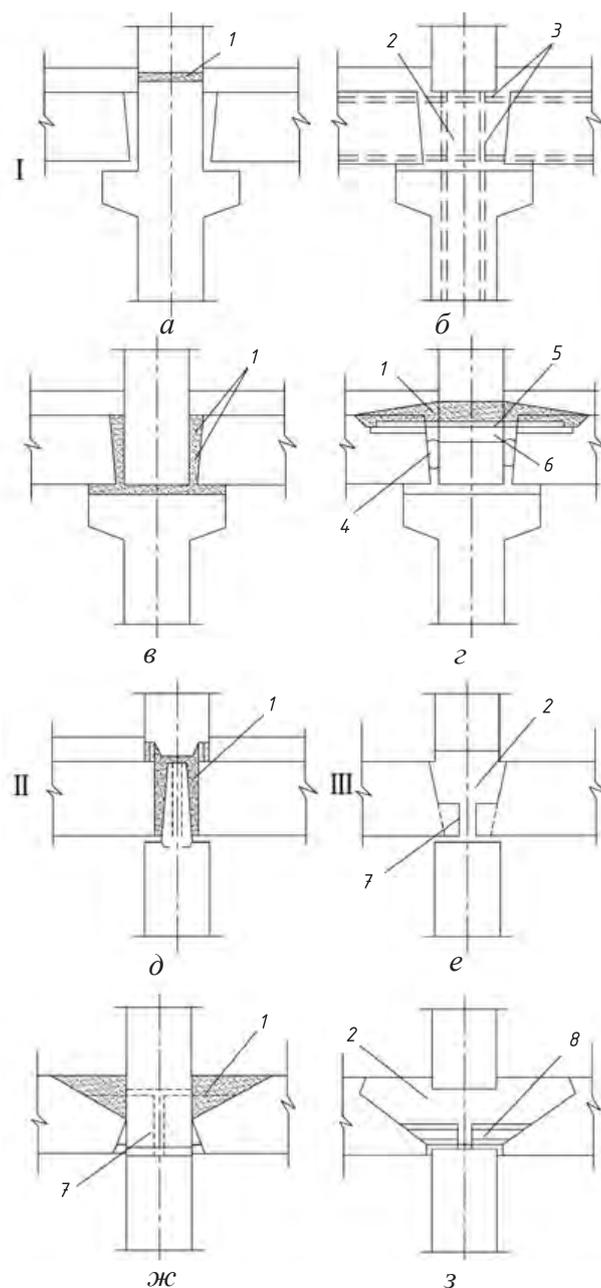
Контактные стыки панелей внутренних стен: I — с опиранием перекрытий на консоли стен: *a* — горизонтальный стык на растворе расположен выше уровня перекрытий; *б* — стык через монолитное ядро; *в* — стык на растворе в уровне низа перекрытий; *г* — то же, в зоне связей между перекрытиями через отверстия панели стены; II — контактно-гнездовой стык: III — контактные стыки на пальцах (бетонных или стальных): *д* — через монолитное бетонное ядро; *е* — через растворный шов в уровне низа перекрытий; *ж* — через монолитное бетонное ядро при опирании панелей перекрытия пальцами из стальных коротышей; *з* — через монолитное бетонное ядро при опирании панелей перекрытия пальцами из стальных коротышей: 1 — цементный раствор; 2 — монолитный бетон; 3 — арматурные выпуски; 4 — звукоизоляционные прокладки; 5 — стальная накладка; 6 — отверстие в стеновой панели; 7 — железобетонный «палец»; 8 — стальной «палец»
